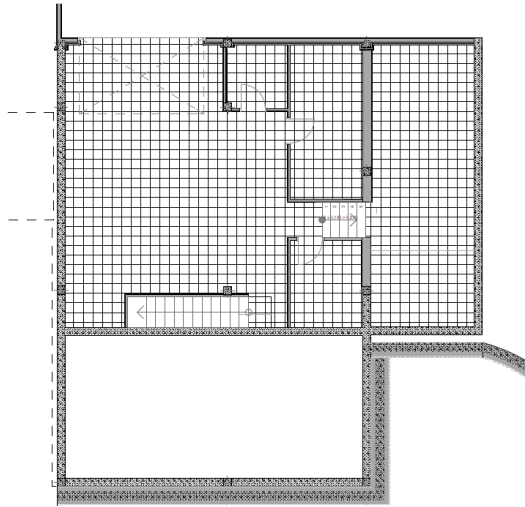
Planta Semisótano. Fuente propia. Archicad 20. 2018.
